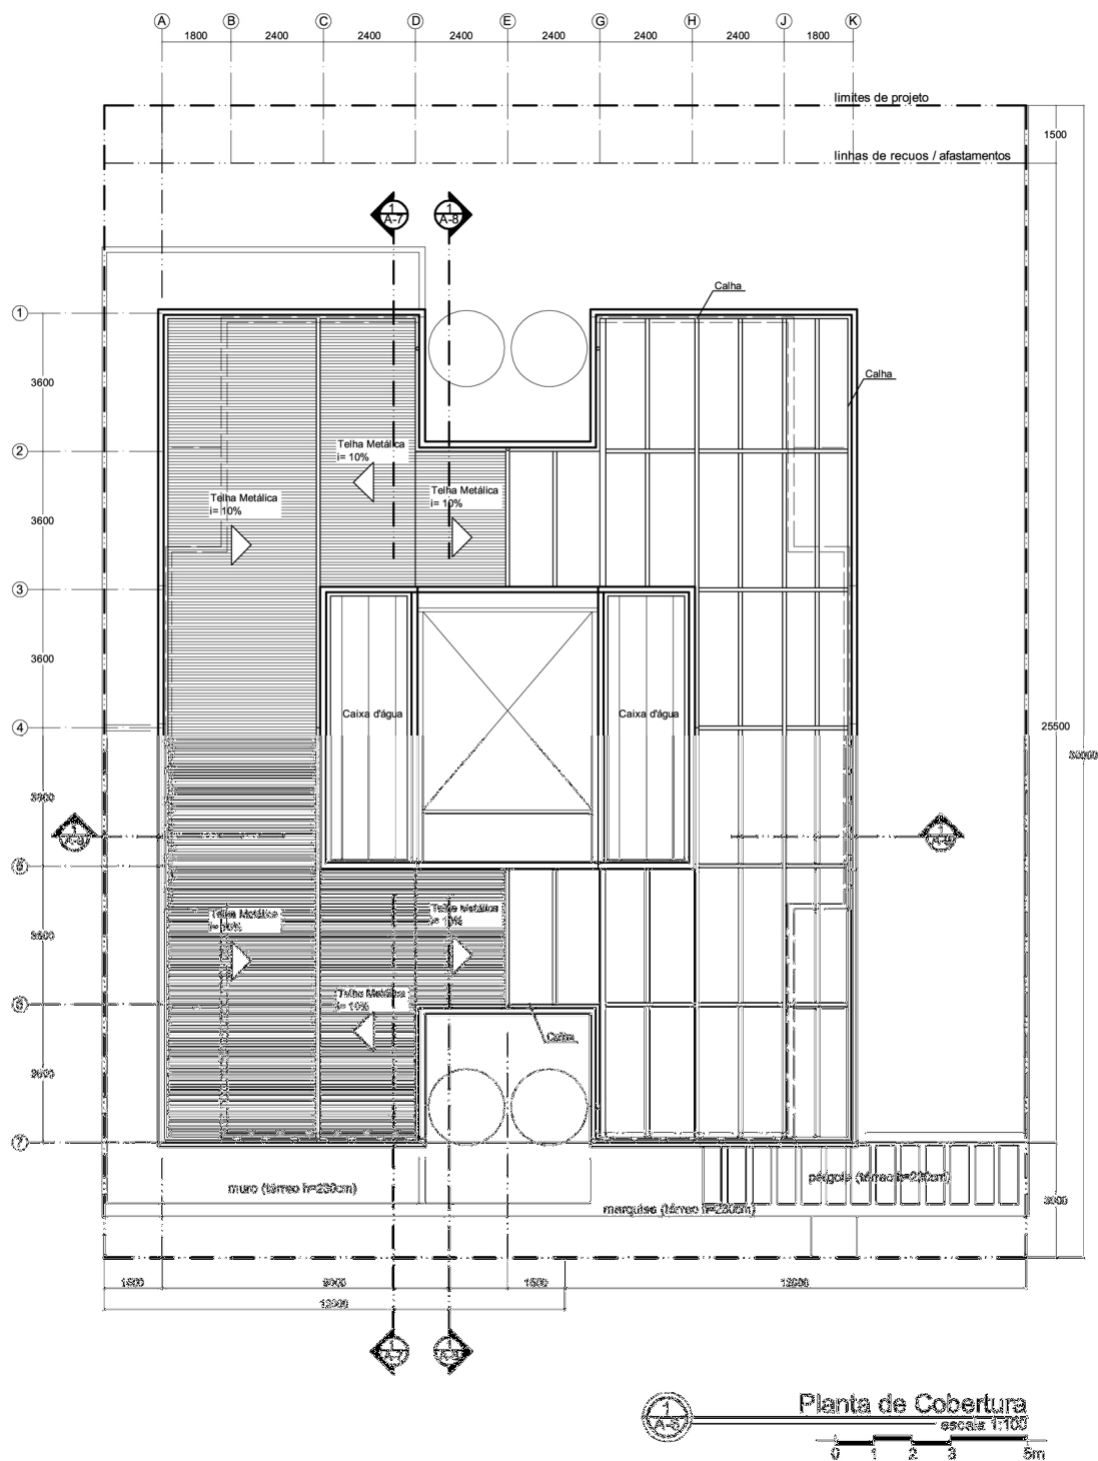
Planta cobertura. Fonte: Arquivo do autor
